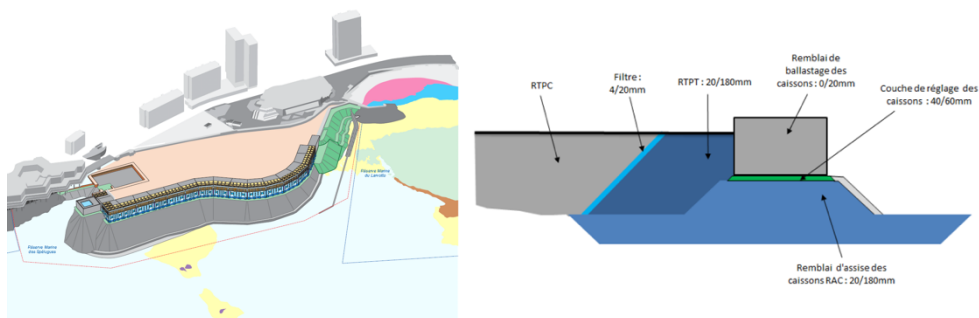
Plateforme comprenant la ceinture de caissons et les systèmes de protection et de remblai (vue en plan et coupe) [22].
